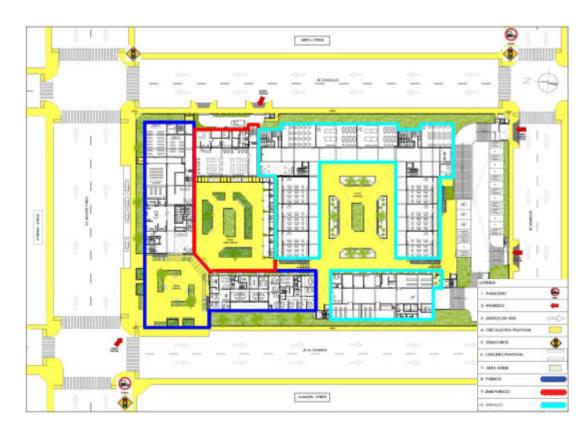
Plan maestro del proyecto Elaboración: la autora
